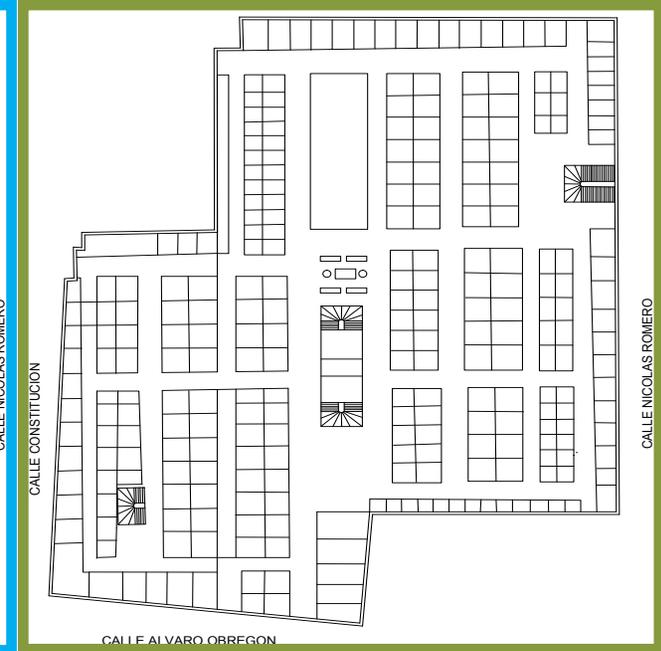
Planta del mercado Tariacuri nivel 2.
